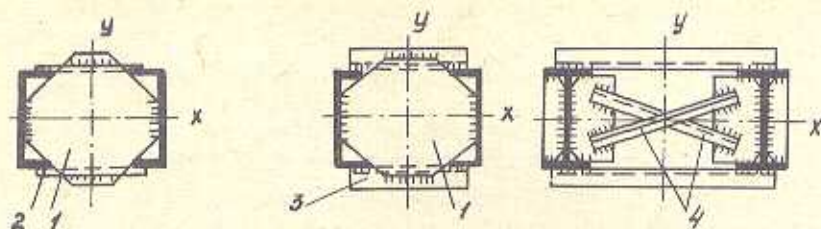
Схема установки поперечных диафрагм жесткости
